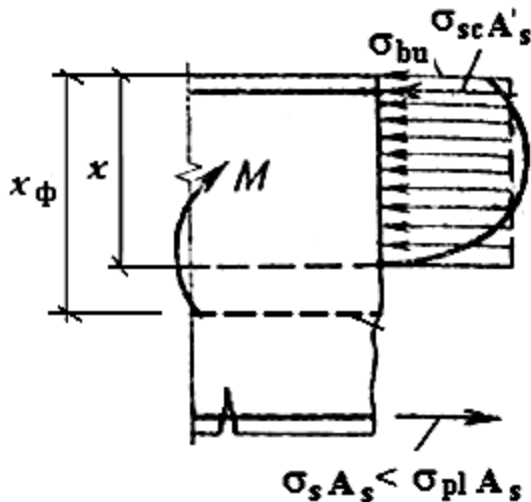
Стадія III напружено-деформованого стану. Випадок 2. (Руйнування по бетону).
